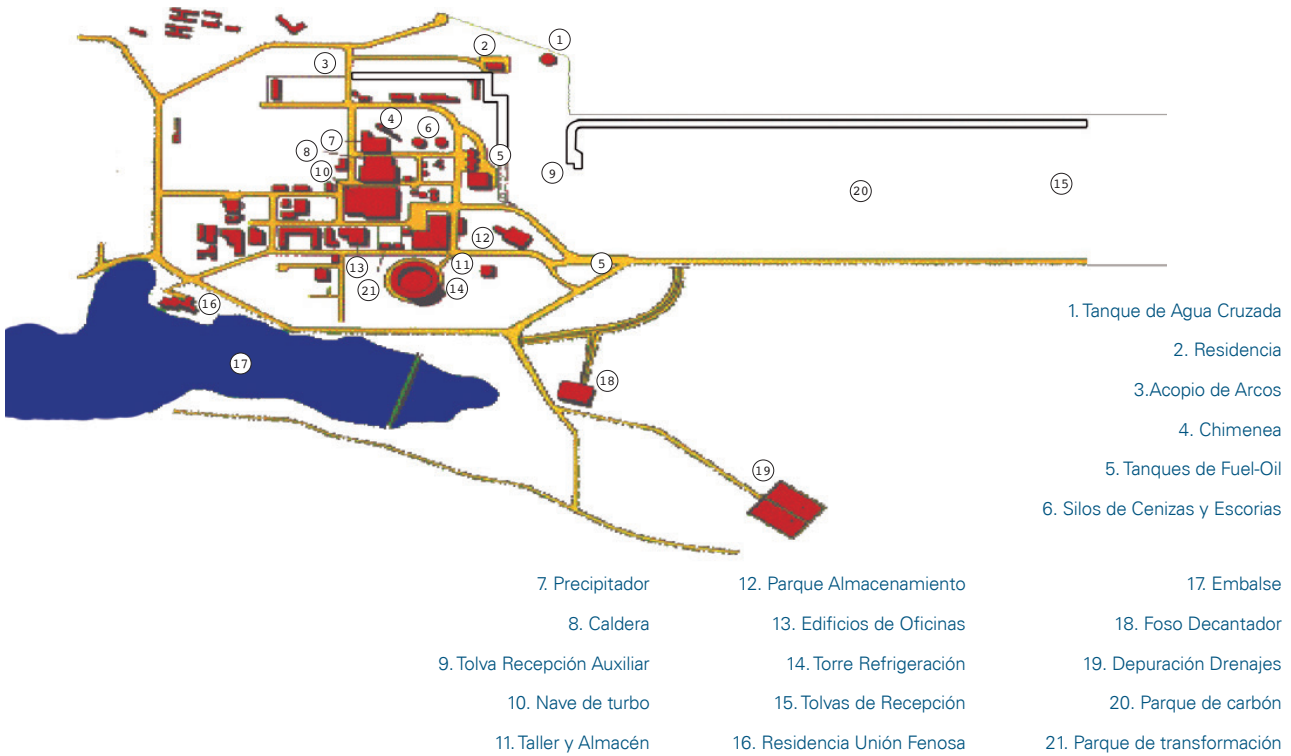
Plano de Planta de la Central Térmica de Anllares
